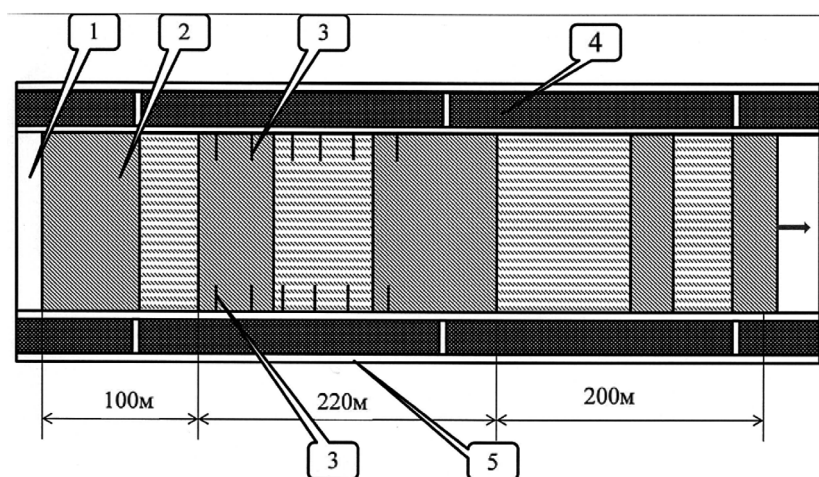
Метод посадки труднообрушаемой кровли с помощью скважин гидроразрыва: 1 – монтажная камера; 2 – выработанное пространство; 3 – скважины гидроразрыва; 4 – угольный целик; 5 – места расположения реперов для измерения смещений
